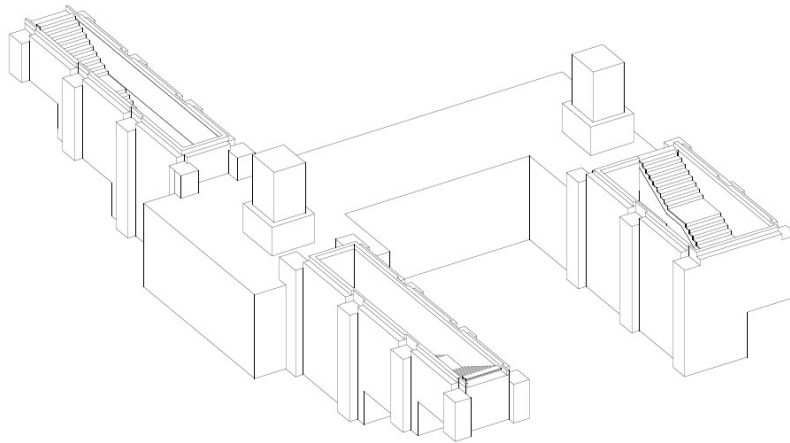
Vista assonometrica corpi scale e sottopasso di stazione
